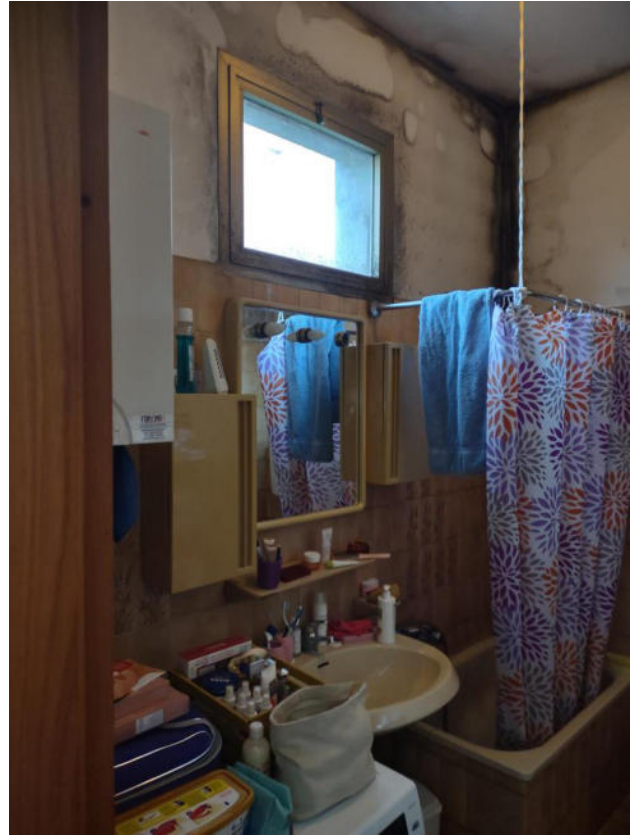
e 10. Abitazione - piano strada: la veranda/antibagno e il bagno
